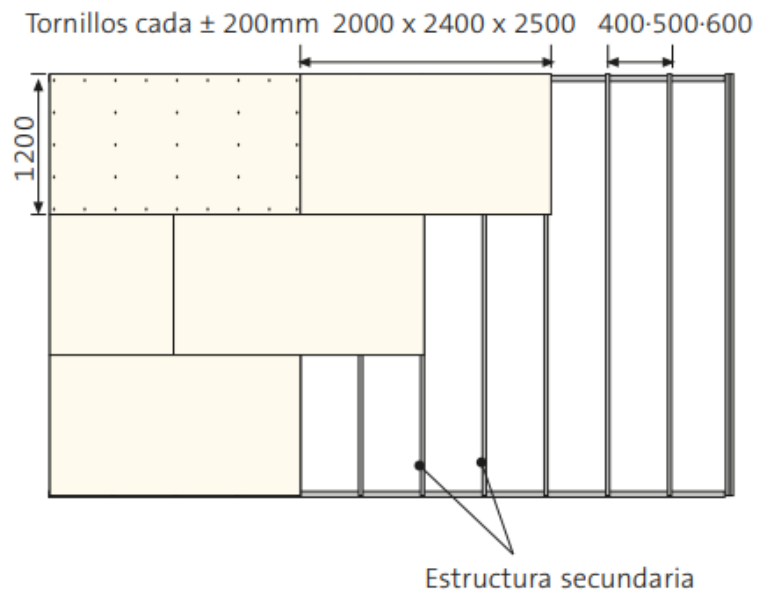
Distribución estructura Falso Techo continuo Fuente: placo.es
